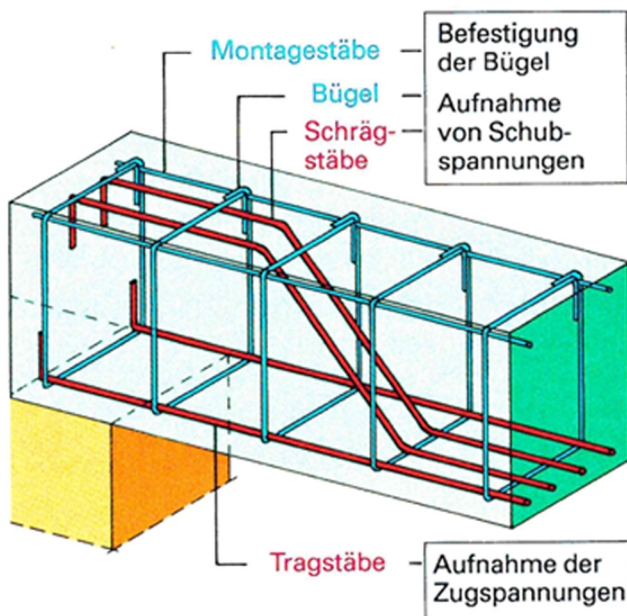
Bewehrung eines Stahlbetonbalkens im Auflagerbereich (Batra et al. 2016, S. 150).
